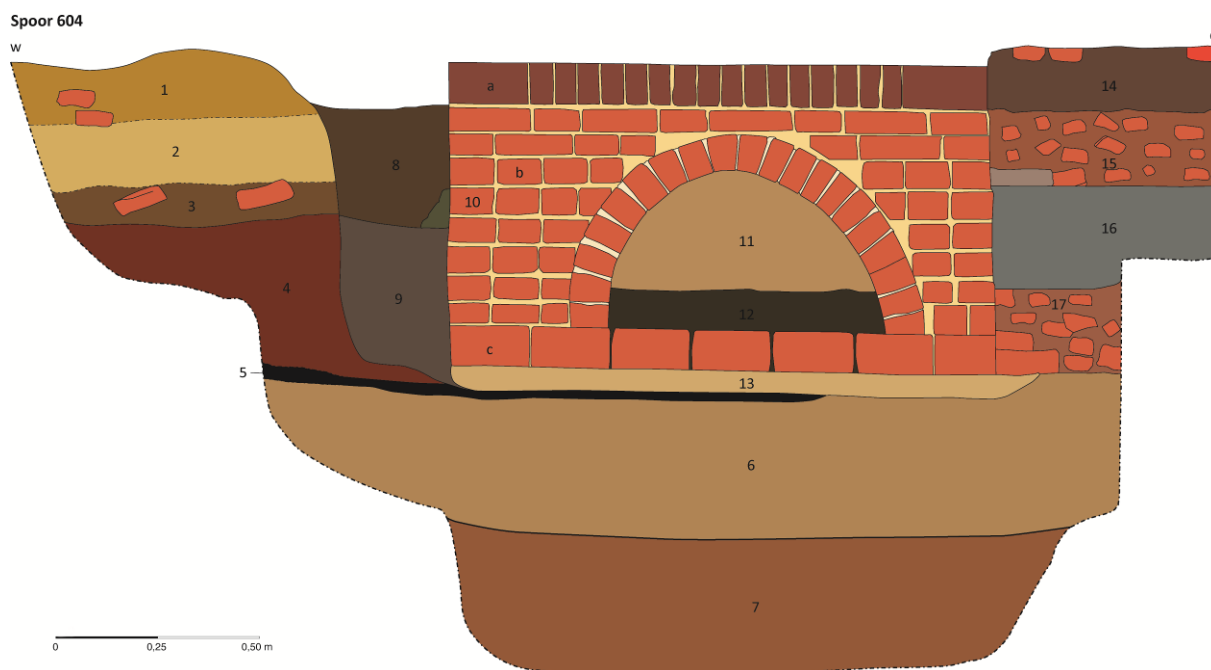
Coupetekening noordelijke uiteinde Duiker 1
